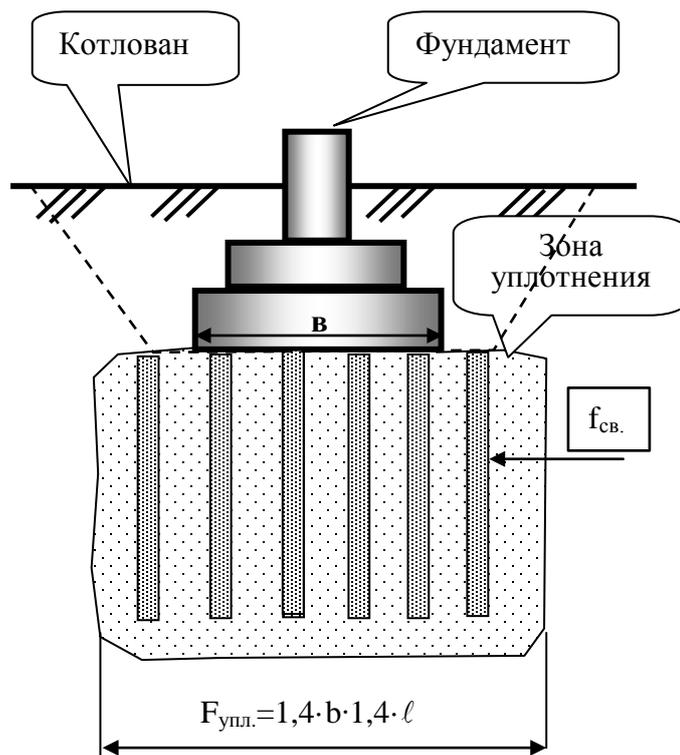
Схема использования песчаных свай для уплотнения основания:
